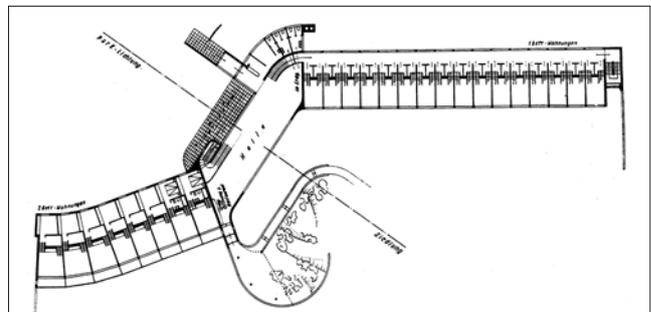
Breslau, Ledigenheim auf der Werkbundausstellung, Hans Scharoun, 1929, Grundriss
